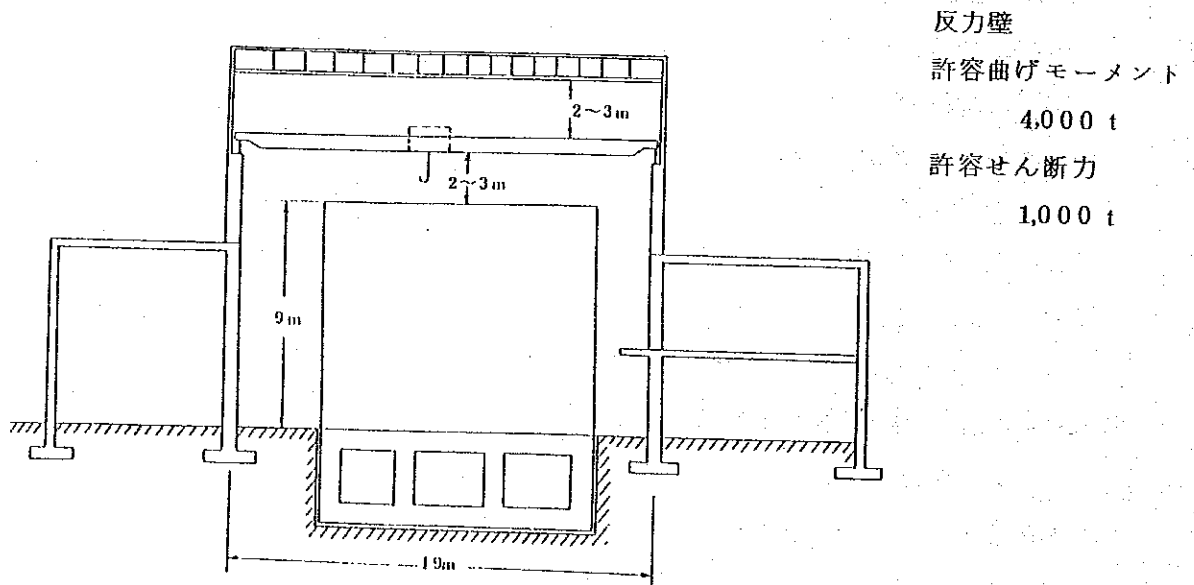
STRUCTURAL TESTING LAB ELEVATION 1/200
